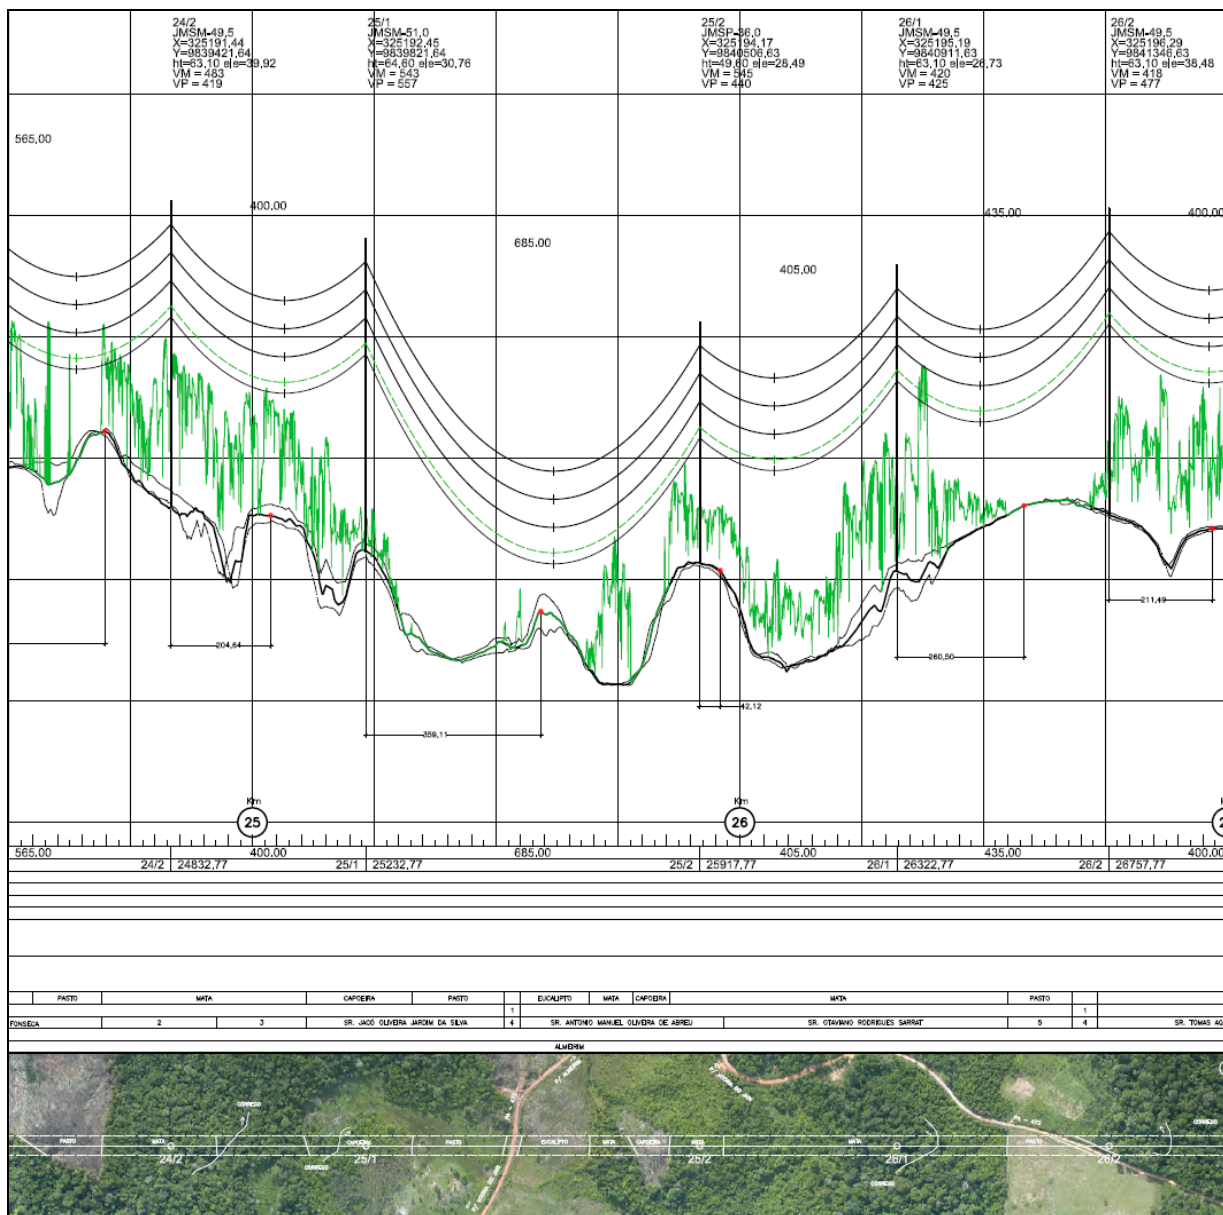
Trecho da planta perfil com mapeamento da vegetação (linha verde) com utilização de laser.
